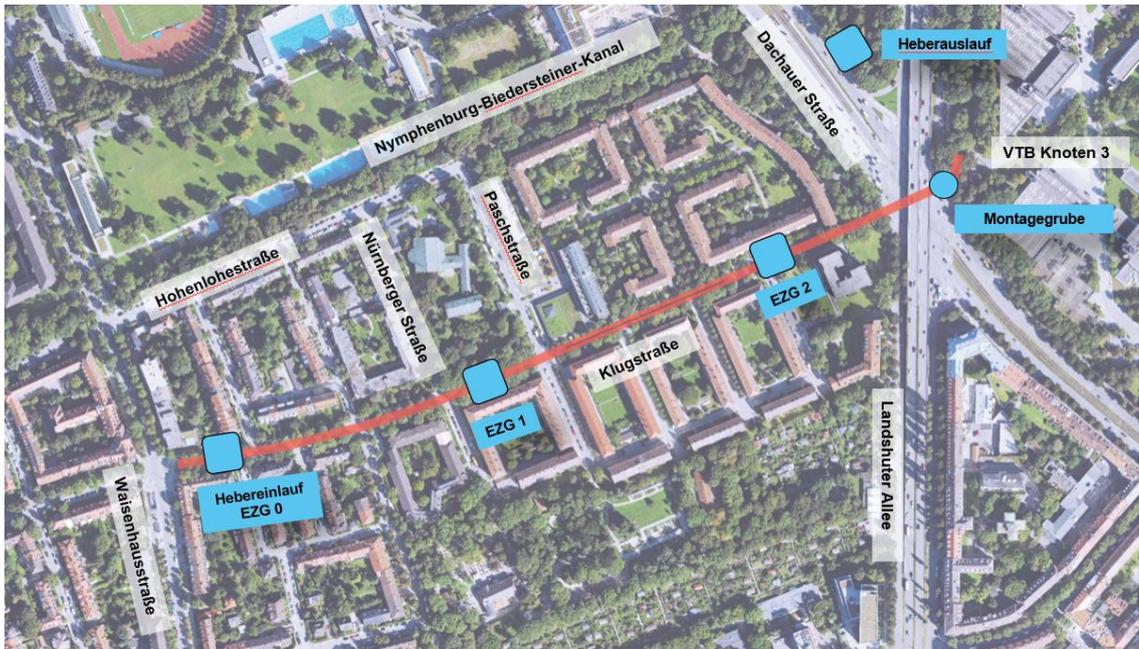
Standorte Baugruben Sanierungsabschnitt West - Klugstraße
